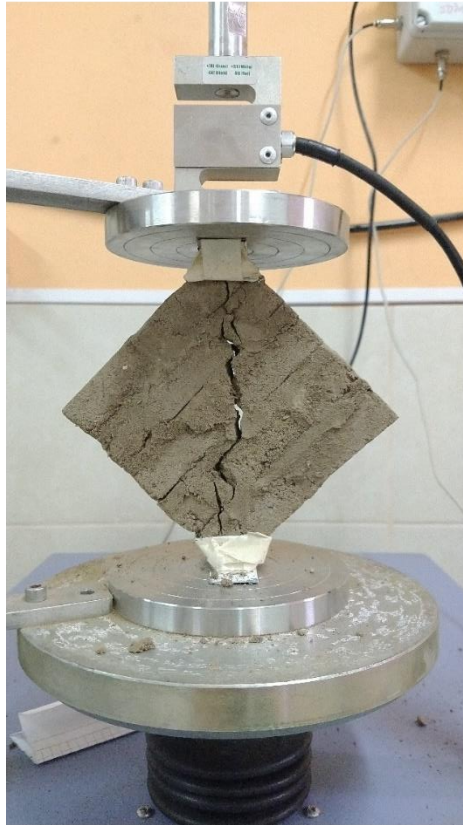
Primeras fisuras en prototipo de murete de adobe
